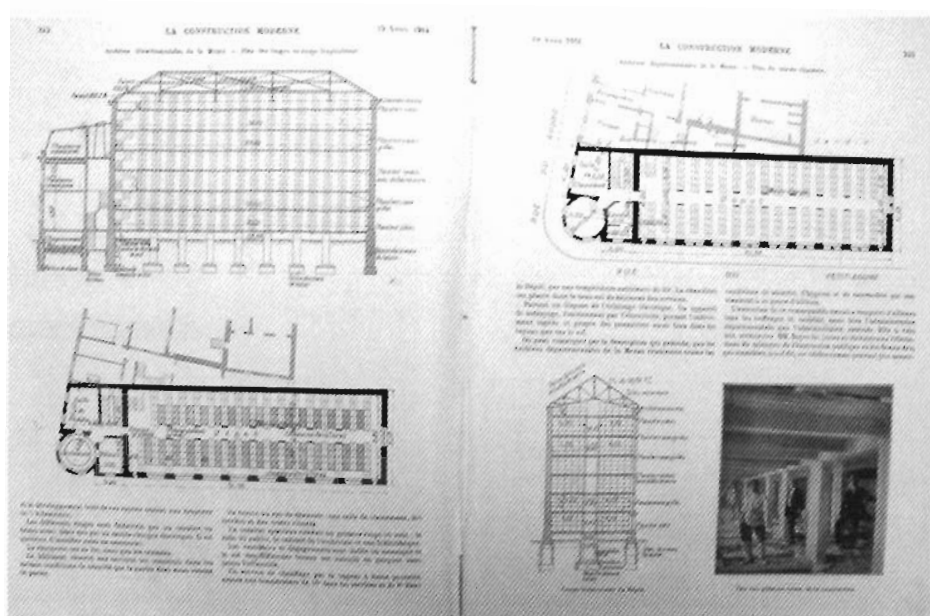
Plans et coupe des archives départementales de la Meuse («La Construction moderne», 19 avril 1914, pp. 342-343).
